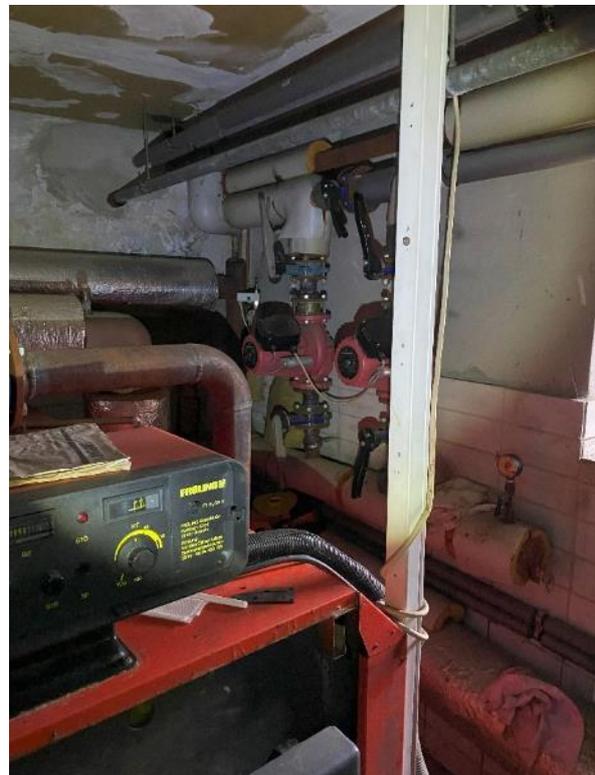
, Heizungs-/Warmwasserleitungsführung zu den Nachbargebäuden
